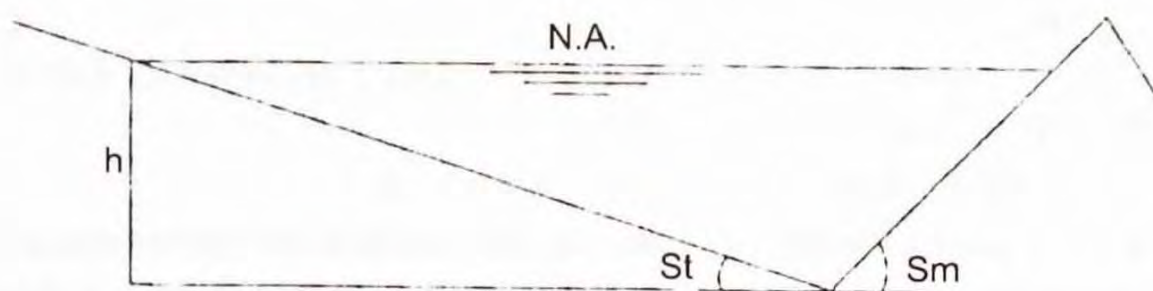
Representação esquemática de um terraço com secção transversal triangular.
